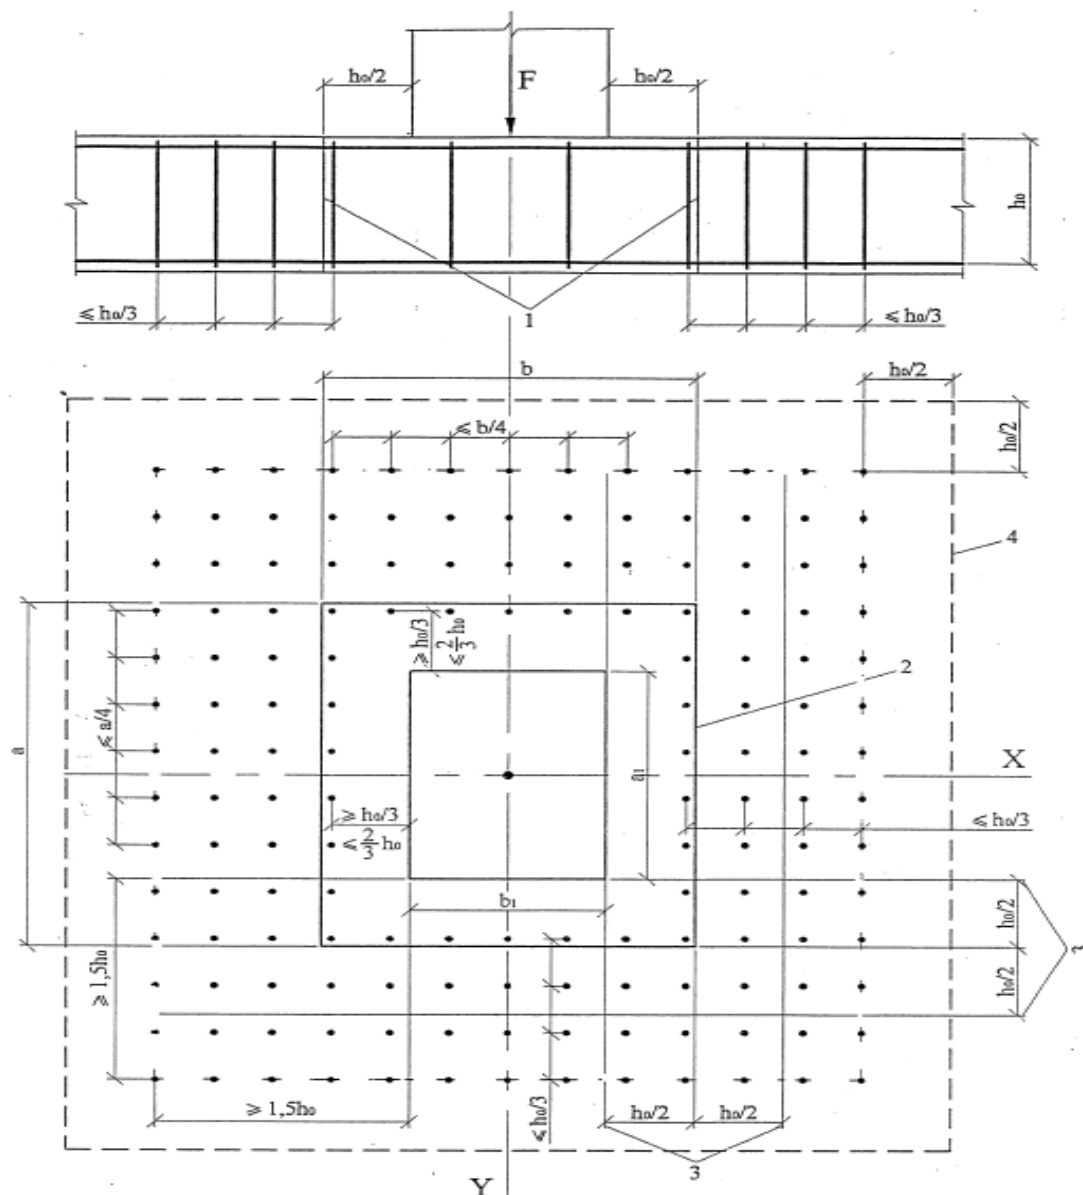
Схема для расчета железобетонных плит с вертикальной равномерной распределенной поперечной арматурой на продавливание.
